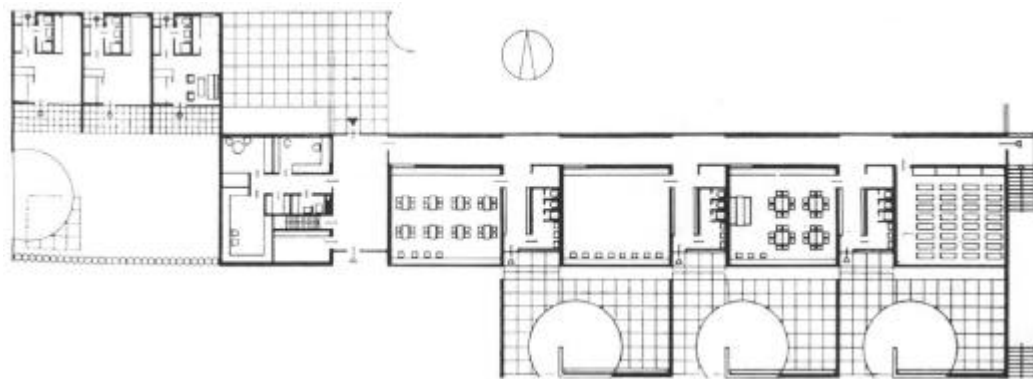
Kindergarten Korneuburg, Grundriß ¹
